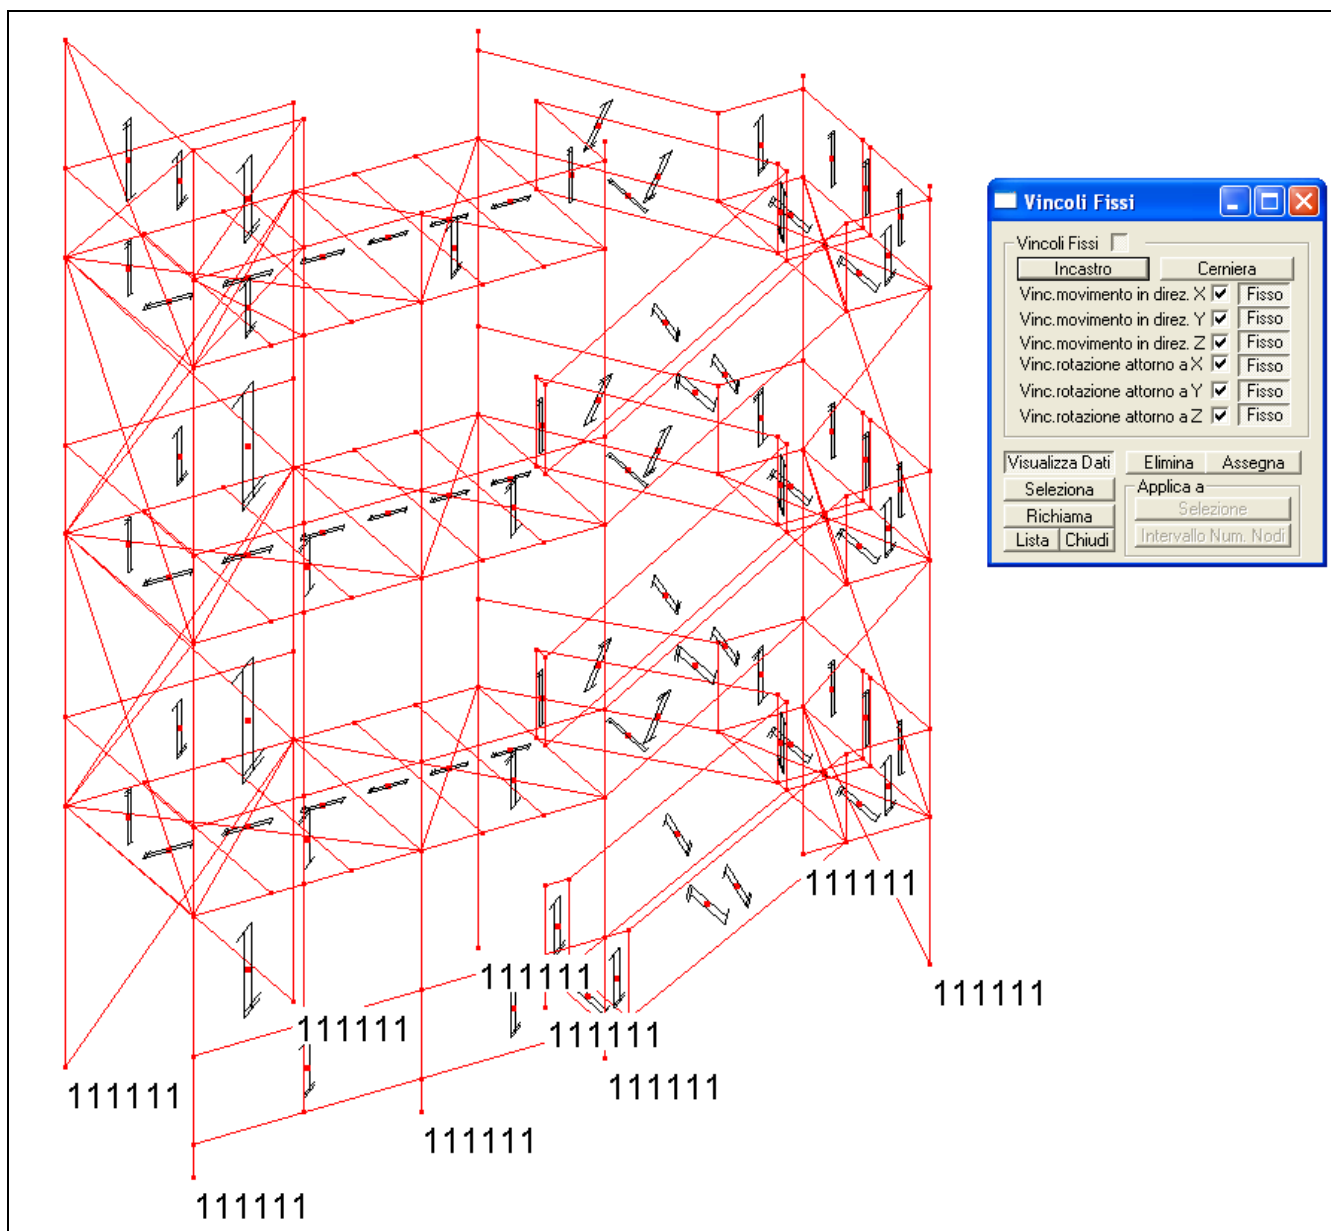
SCHEMA STATICO DEL TELAIO – VINCOLI INCASTRO ALLA BASE
